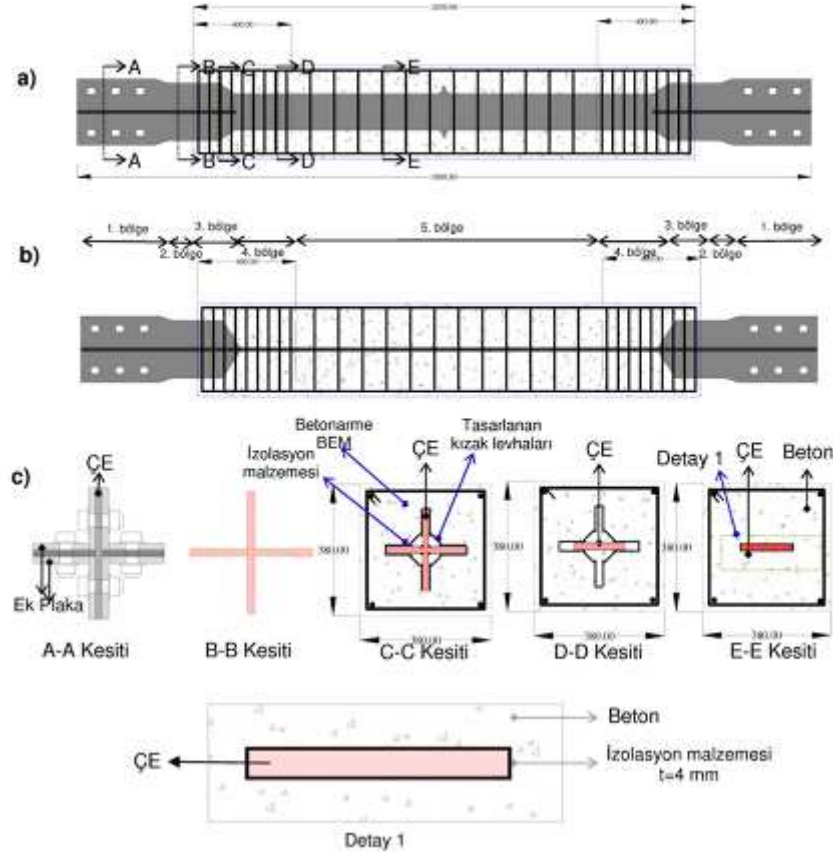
8. BEÇÇ\_1 eleman yapım detayı
